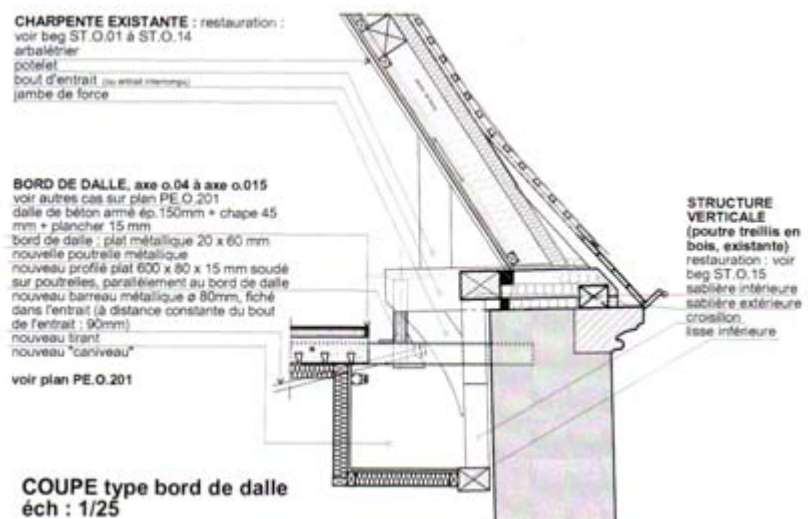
Détail de liaison entre le nouveau plancher et la charpente existante. (Plans-d'exécution, 2007)
